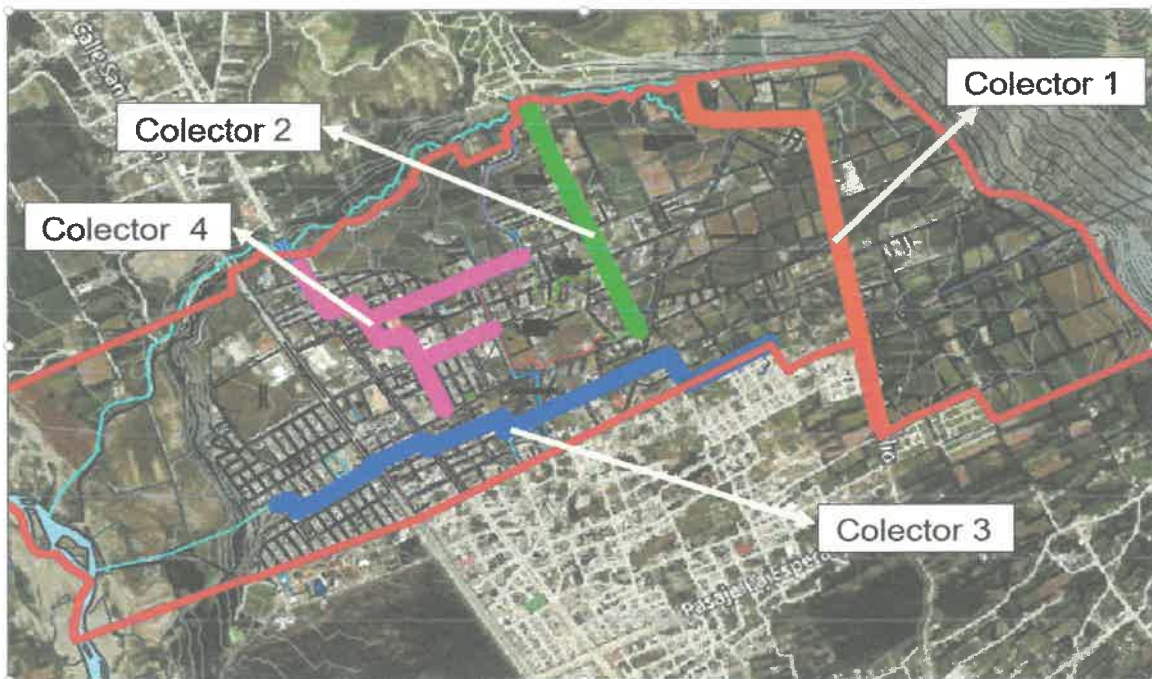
Planteamiento general del sistema de drenaje pluvial del sector NH 17
